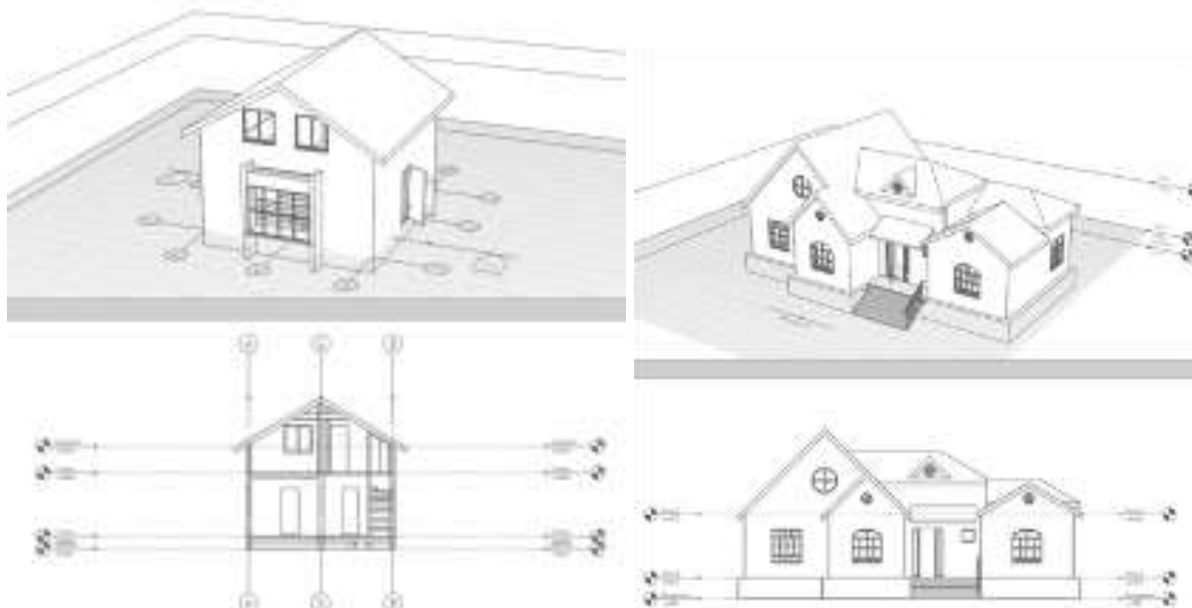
Формирование разреза, фасада здания по 3D модели
